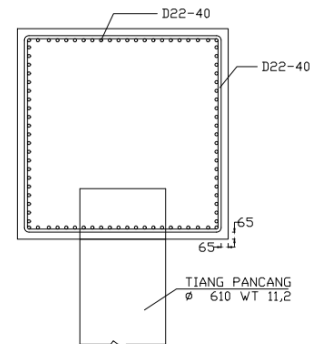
Detail Potongan Memanjang Balok *Trestle
